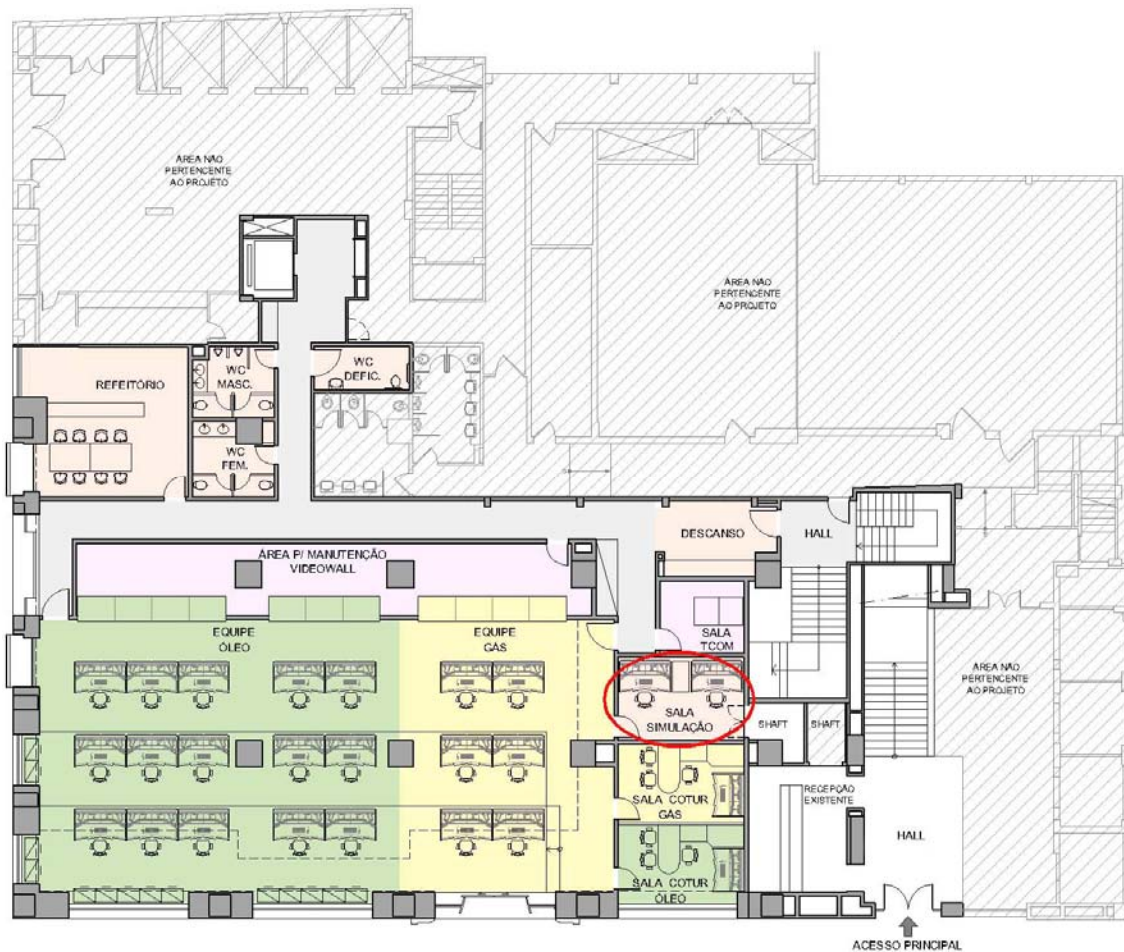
Planta baixa pavimento térreo: layout apresentado à diretoria (quatro de julho)
